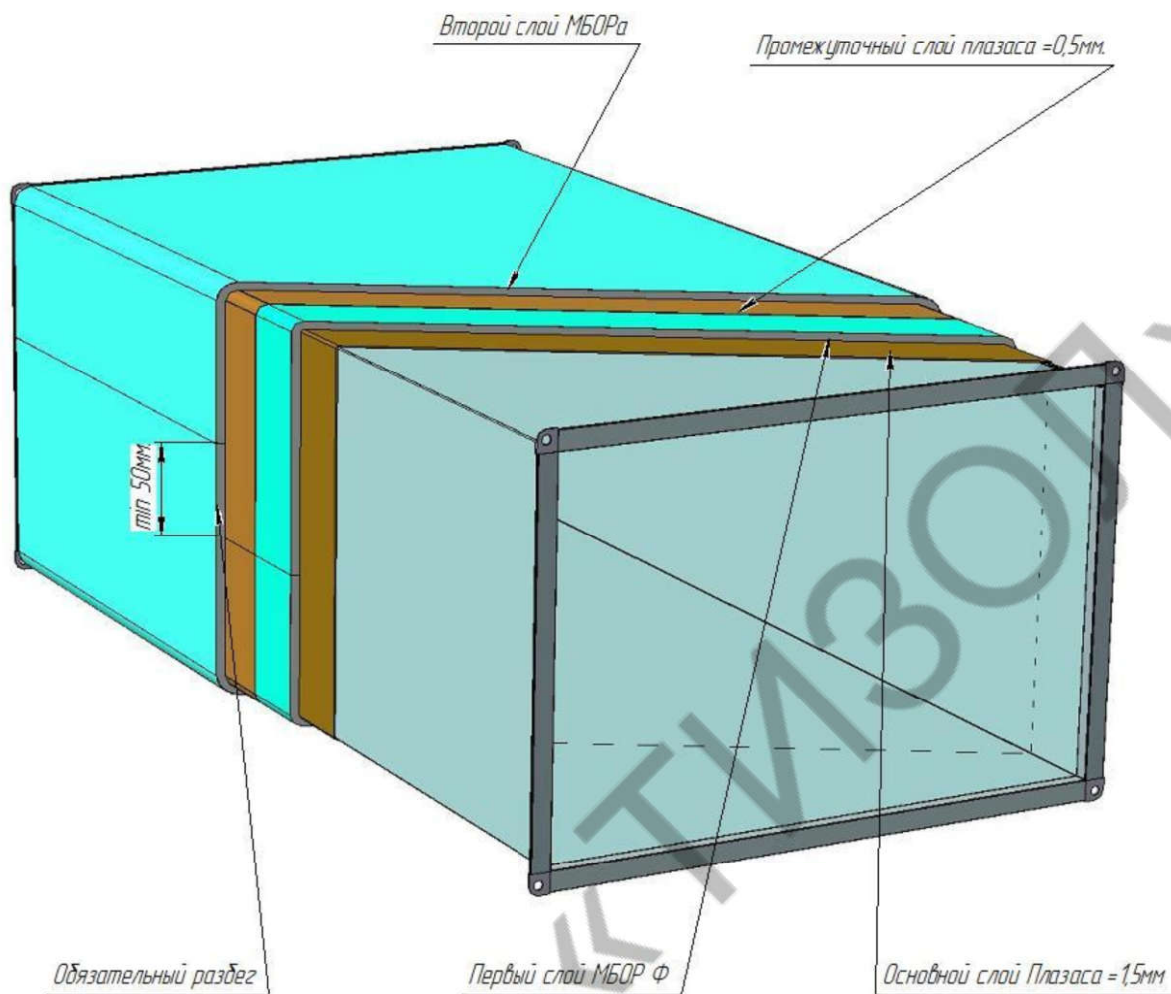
Монтаж системы «ЕТ ВЕНТ» на собранные воздуховоды
